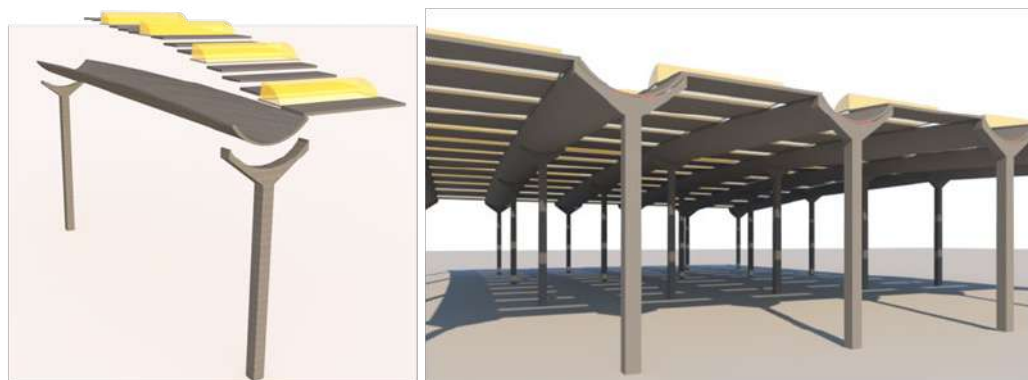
Columnas, canalones, losetas y lucernarios. Figura 3. Vista de un sector de la planta.
